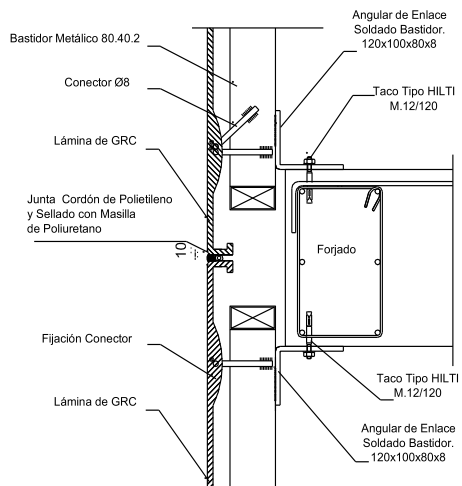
DETALLES FIJACION PANELES STUD- FRAME GRC.
